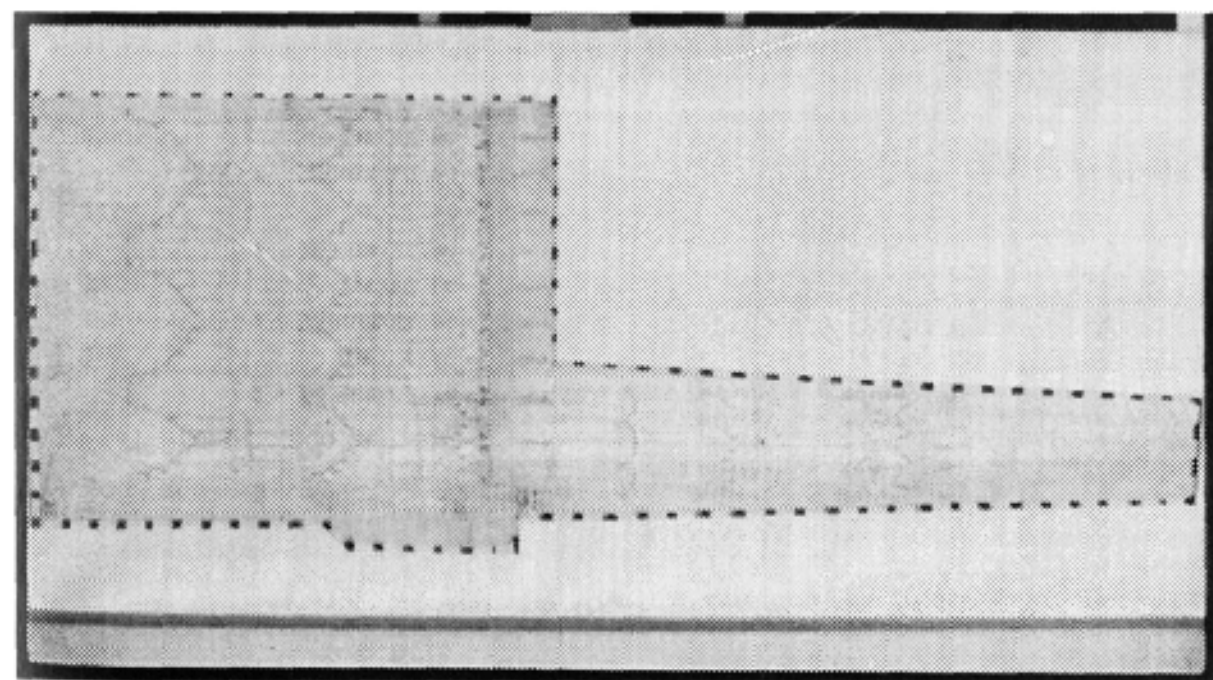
Rathausbauriß nach der Restaurierung mit Passepartout
